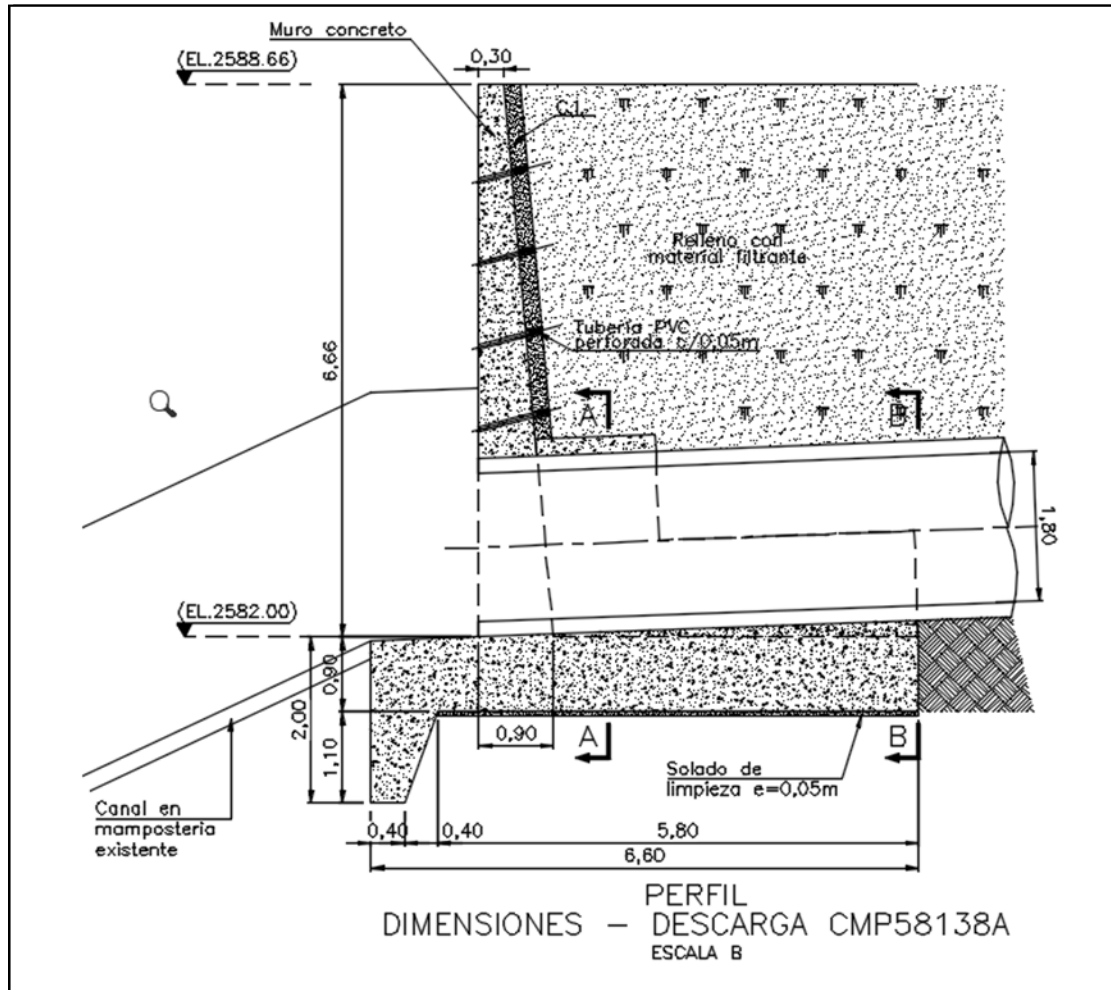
Sección de la estructura de descarga Obra CMP58138A
